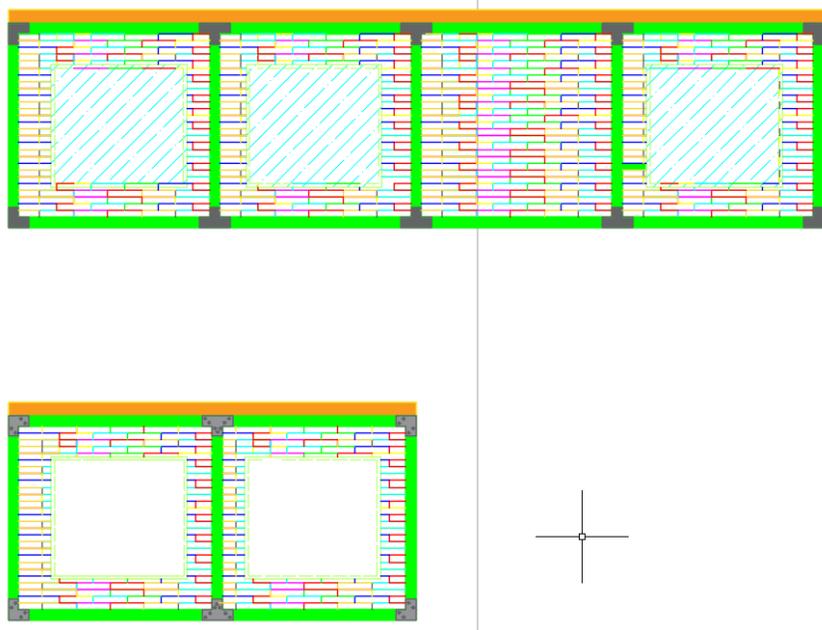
Detalle de Fachadas Fuente: Elaboración propia
